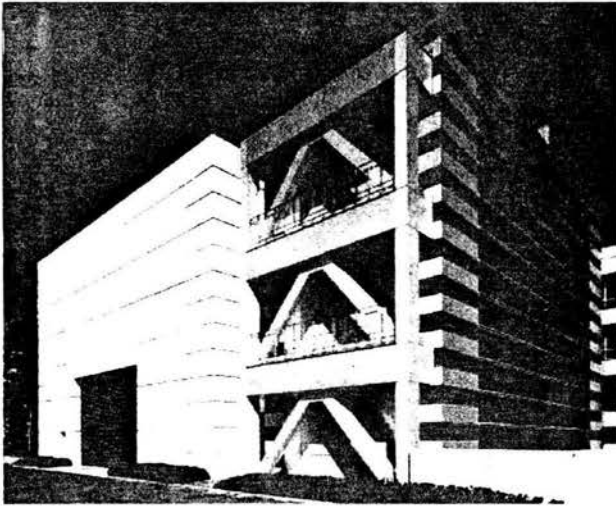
Vista del instituto de investigación Kajima Technical (Connor y Boutros, 1996).
